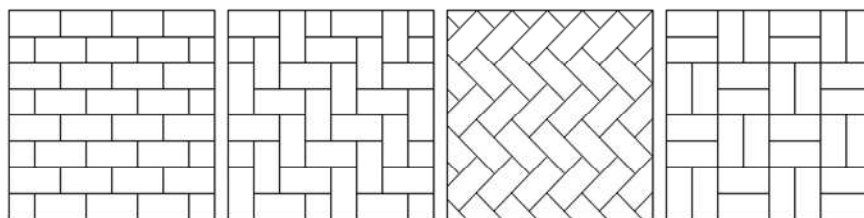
Наиболее распространённые способы укладки тротуарной плитки
